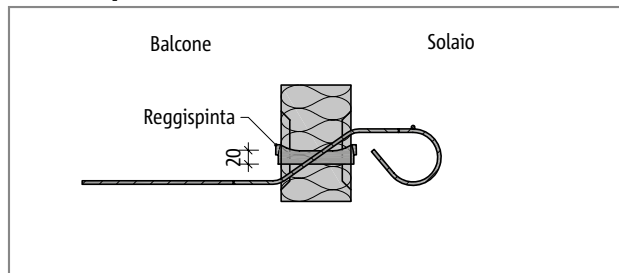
Schöck Isokorb® tipo QXT10 – QXT40: sezione dell'elemento
